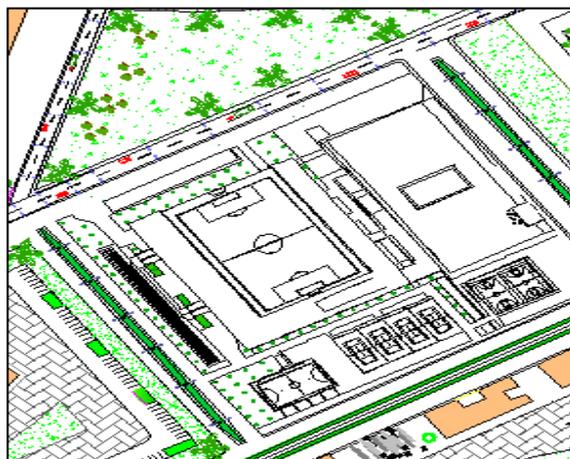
Vue en plan d'un complexe sportif après l'intervention
